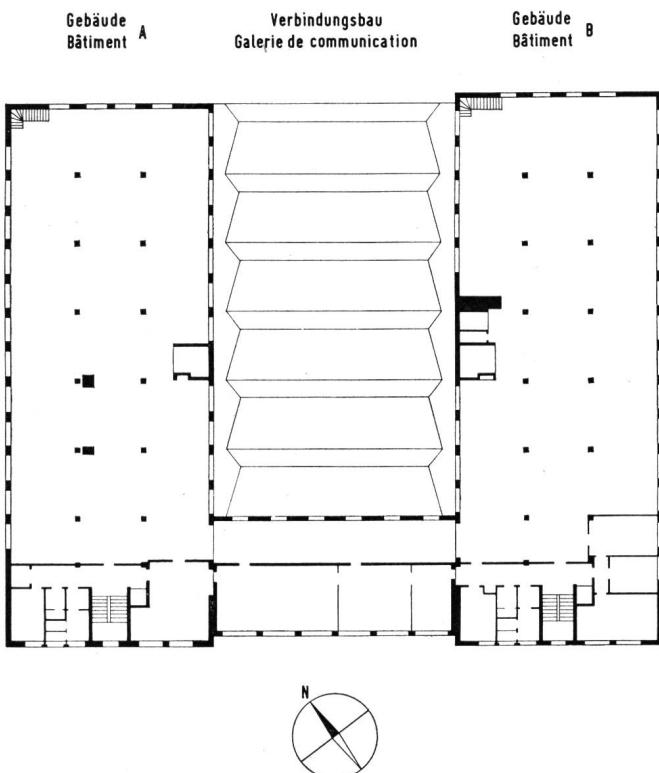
Gebäudegrundriss des TT-Zentralmagazins
